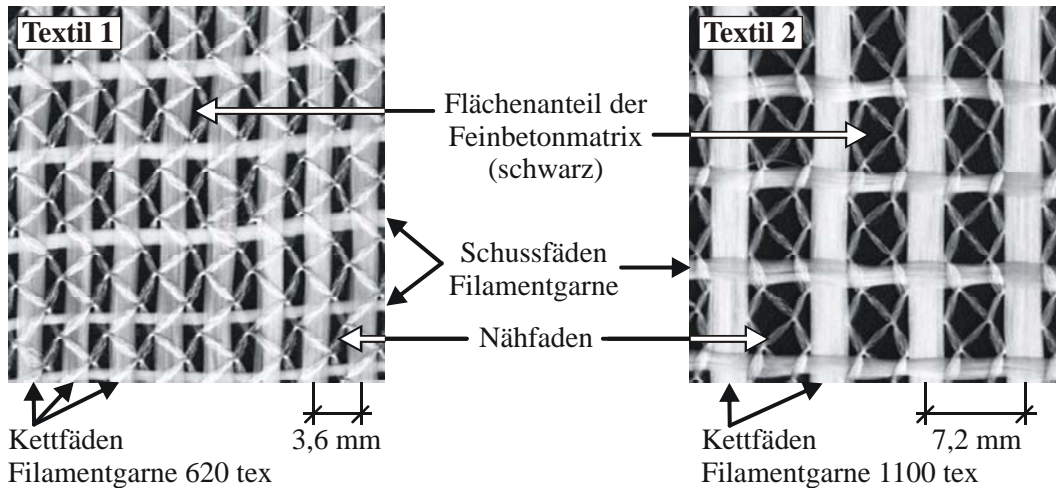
Textile Bewehrungsstrukturen und Flächenanteil der Feinbetonmatrix
